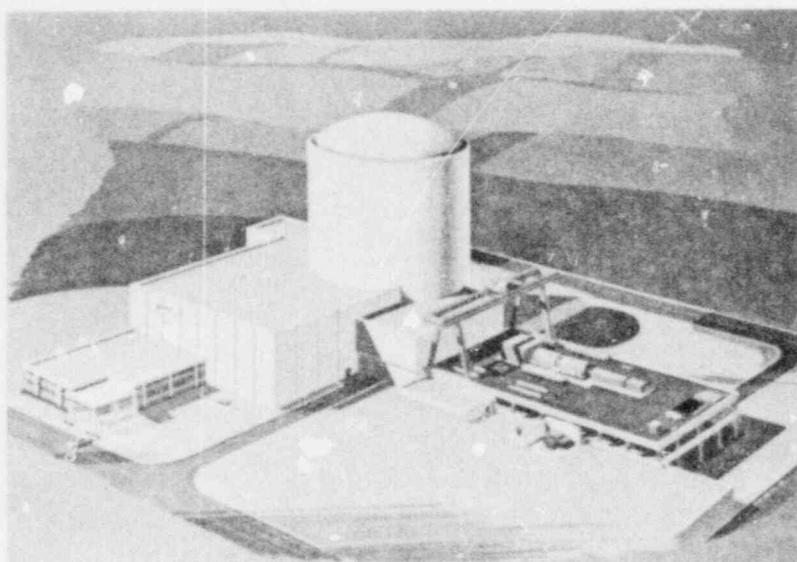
Croquis de diseño de la planta de la costa norte NP-1.
